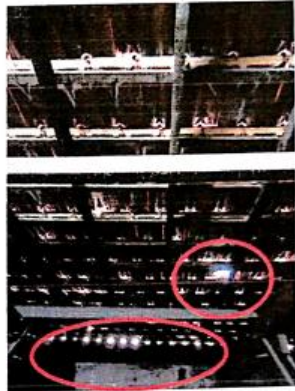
e 35. Telhado Nave Principal – Frestas nas telhas. Nota problemas no beiral.
